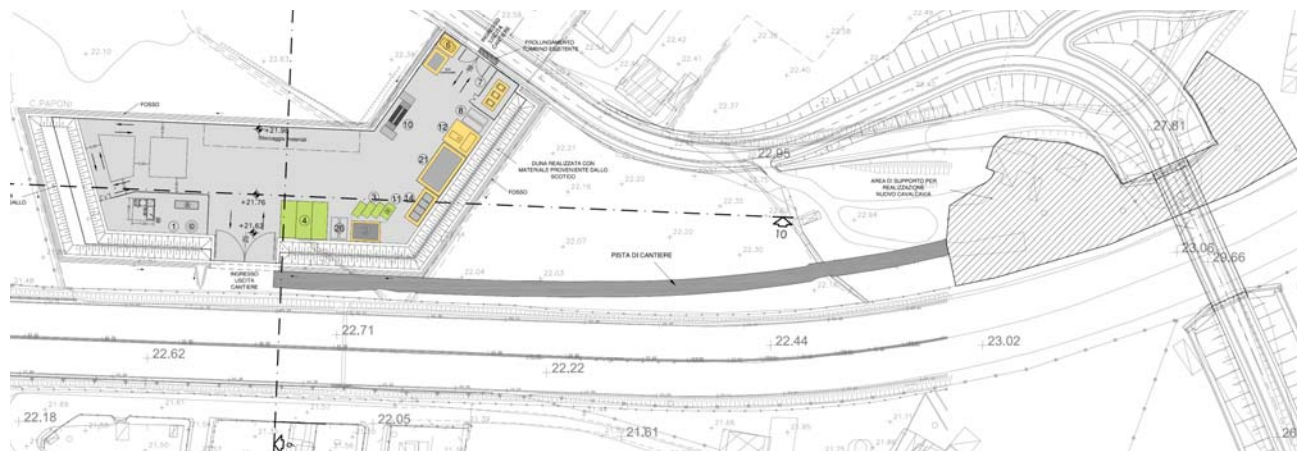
layout area di cantiere CO03 ed area di supporto per realizzazione nuovo cavalcavia
